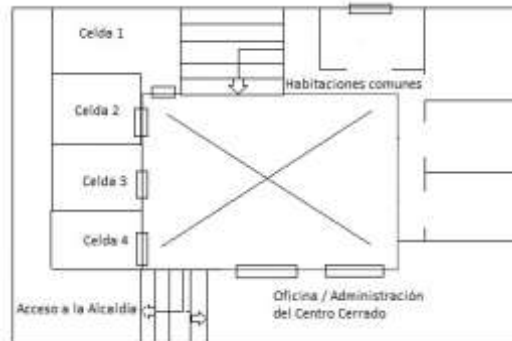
Esquema de distribución de la planta inferior del Centro Cerrado.
